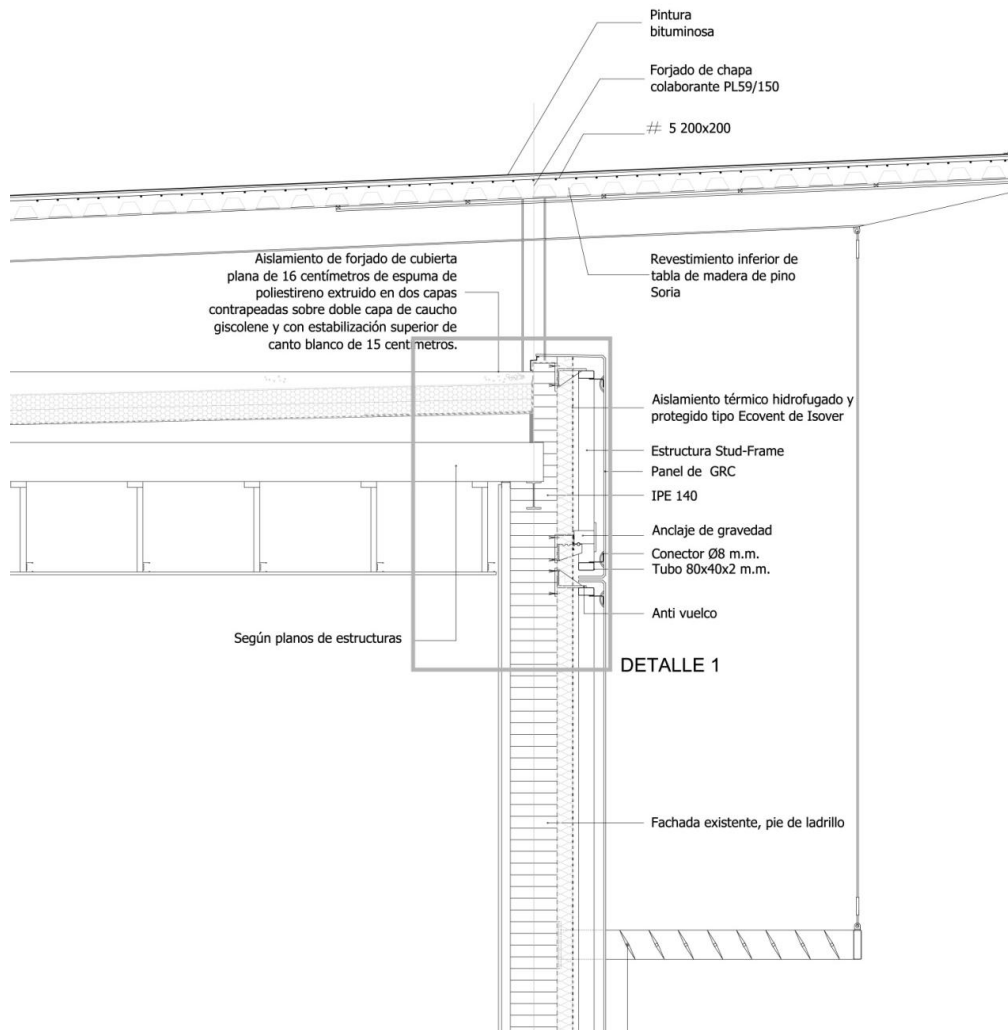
Detalle constructivo de fachada y cubierta. Fuente: Alia arquitectos
